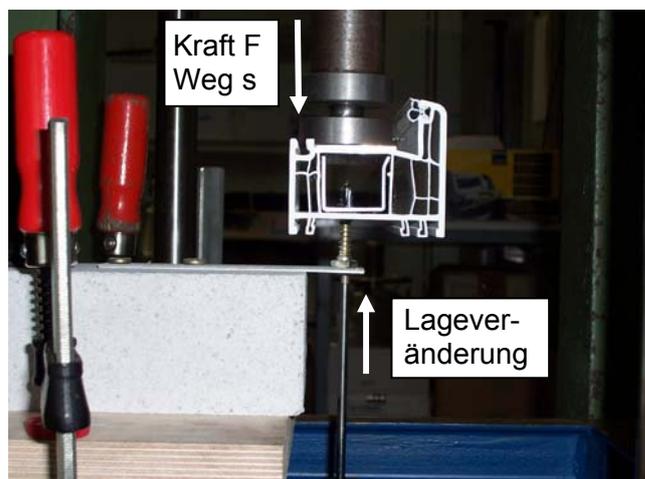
Prüfaufbau Lastaufnahme in Fensterebene
